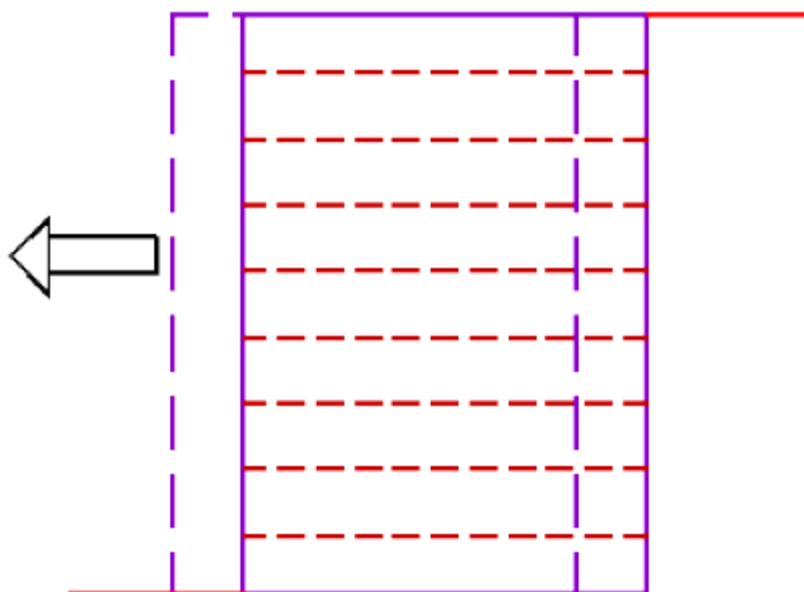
Deslizamiento del bloque reforzado sobre la fundación.
